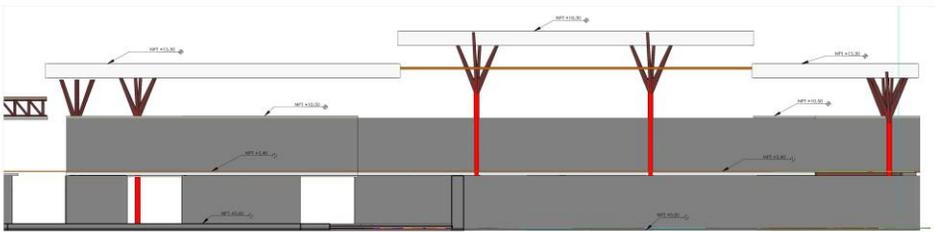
Plano de Cortes elevaciones de sector II – Plano II, elaboración propia.
